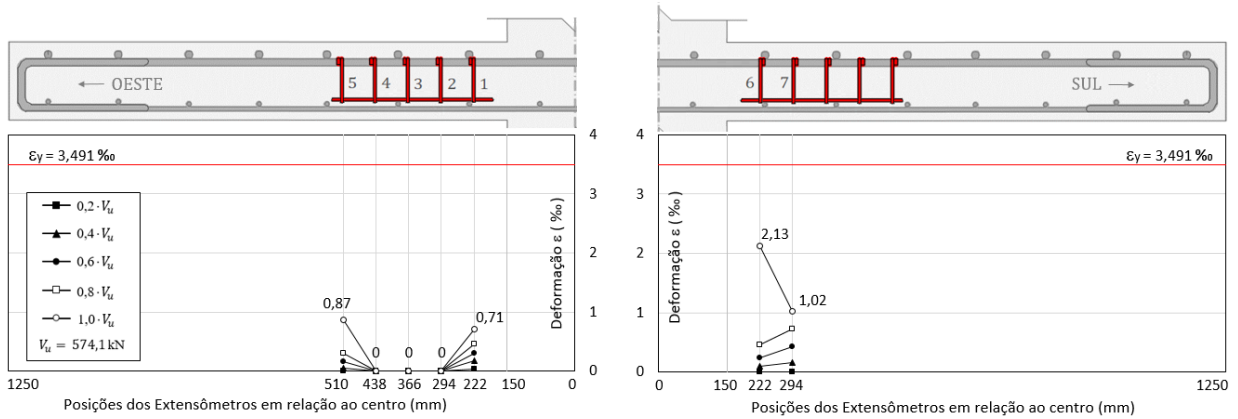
Deformações nas armaduras de cisalhamento da laje TA-05
